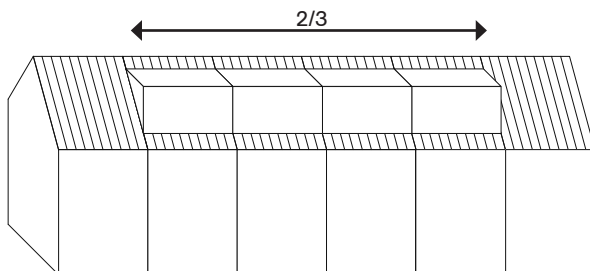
Werden die im Bebauungsplan gestellten Anforderungen auf die Gebäudegruppen angewandt, ergibt sich eine ruhigere Dachform mit Differenzierung einzelner Reihenhäuser.
